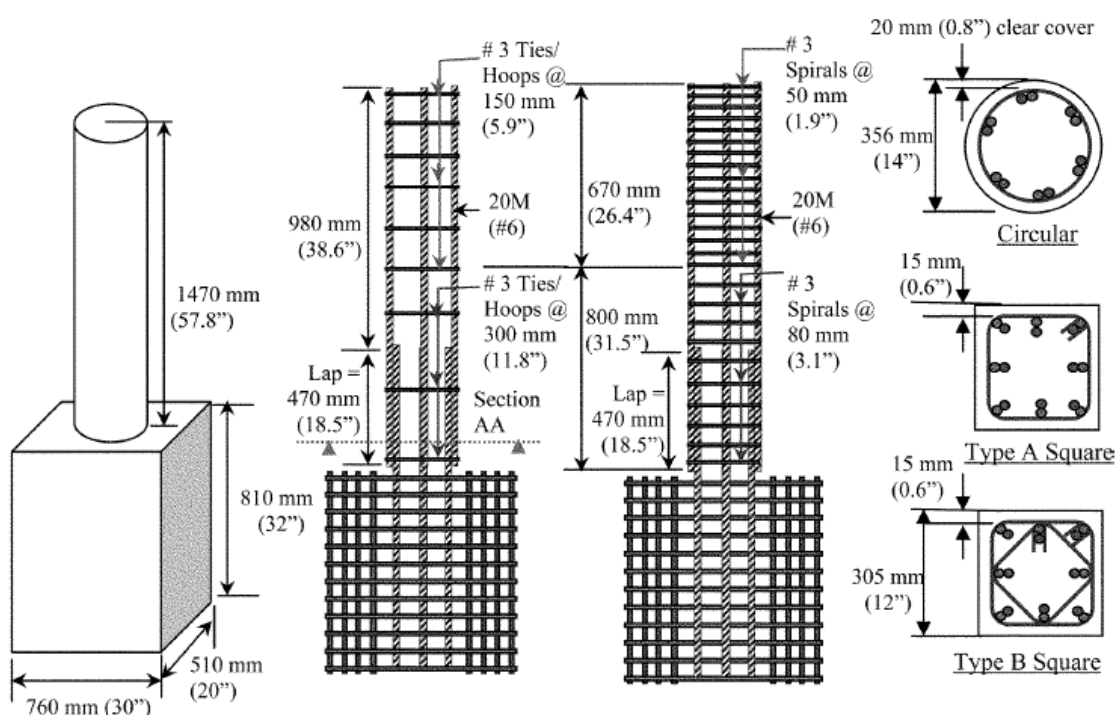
Detalle de las probetas ensayadas [Ghosh K.K., S.A. Sheikh (2007)]
